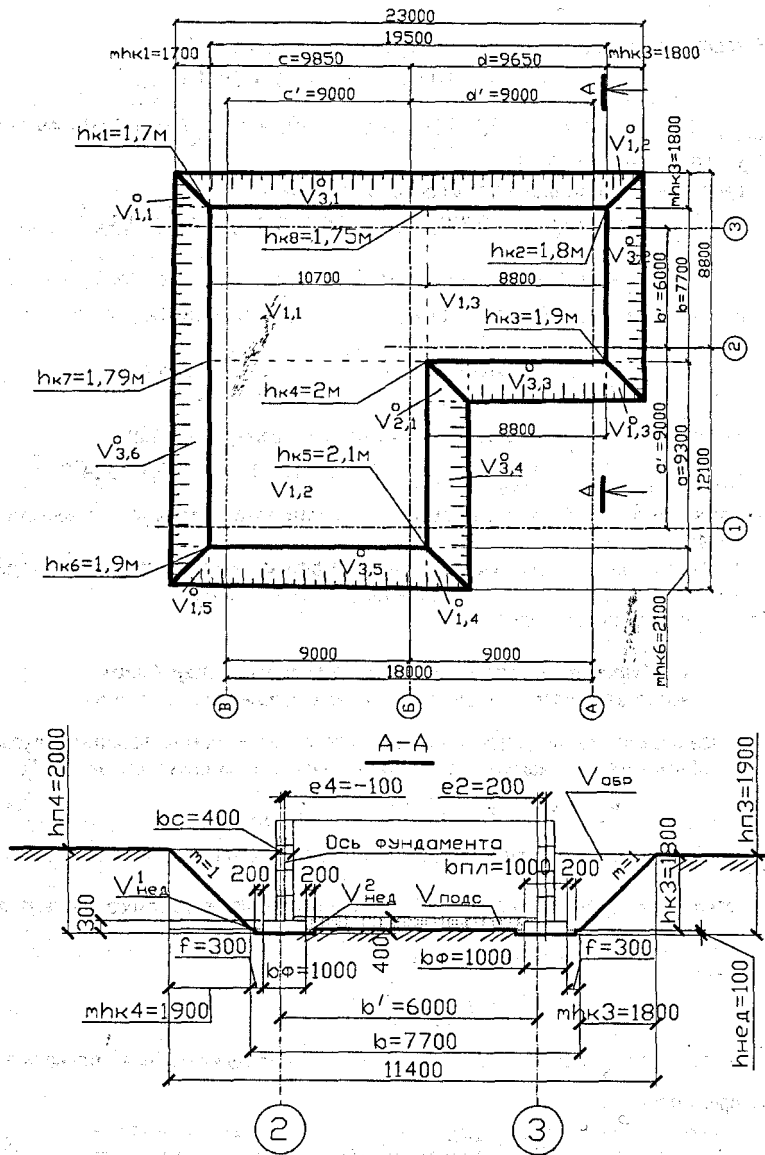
Схема к определению объемов земляных работ при разработке сложного котлована с разной глубиной по периметру под сборные ленточные фундаменты ступенчатого сечения в песчаных грунтах
